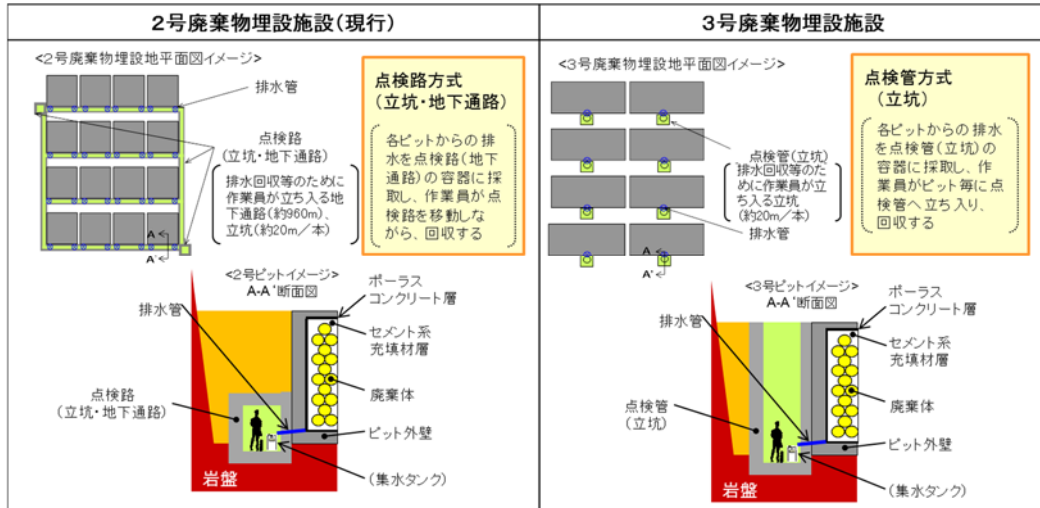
－2 2・3号廃棄物埋設施設の埋設地平面図・埋設設備区画断面図
